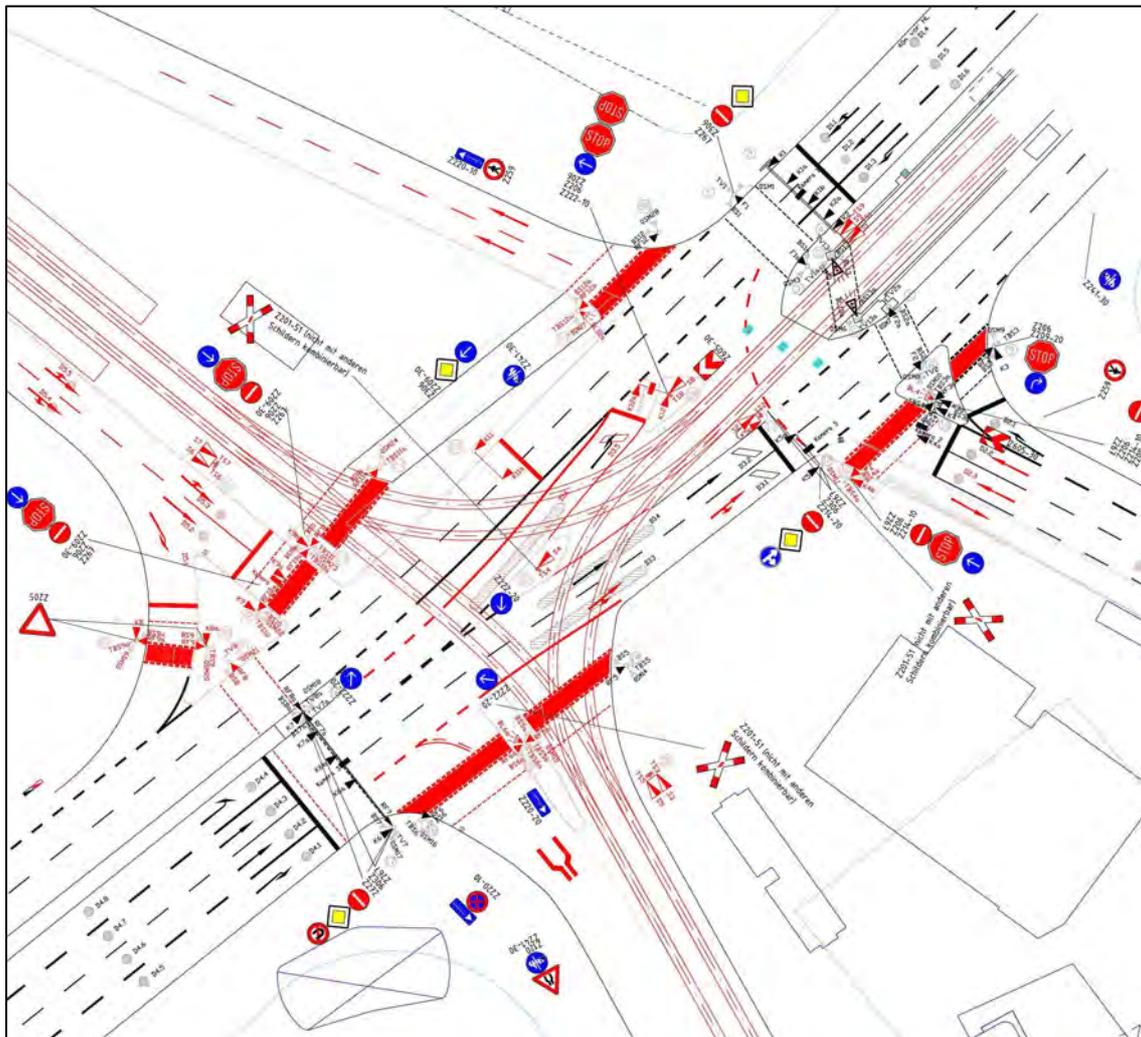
Signallageplan K122 Montpellierbrücke, Variante ohne Underfly
